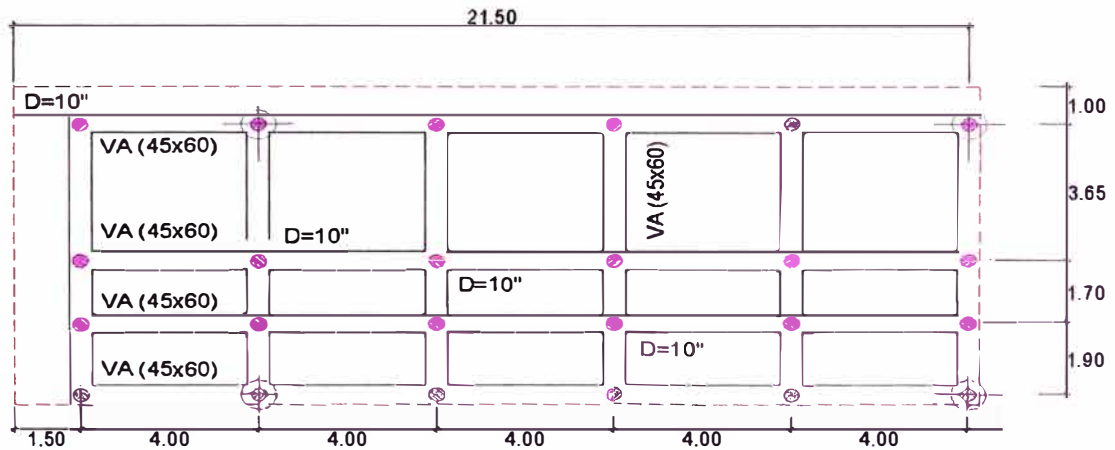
Distribución de pilotes y vigas de arriostre en el 3er tramo
